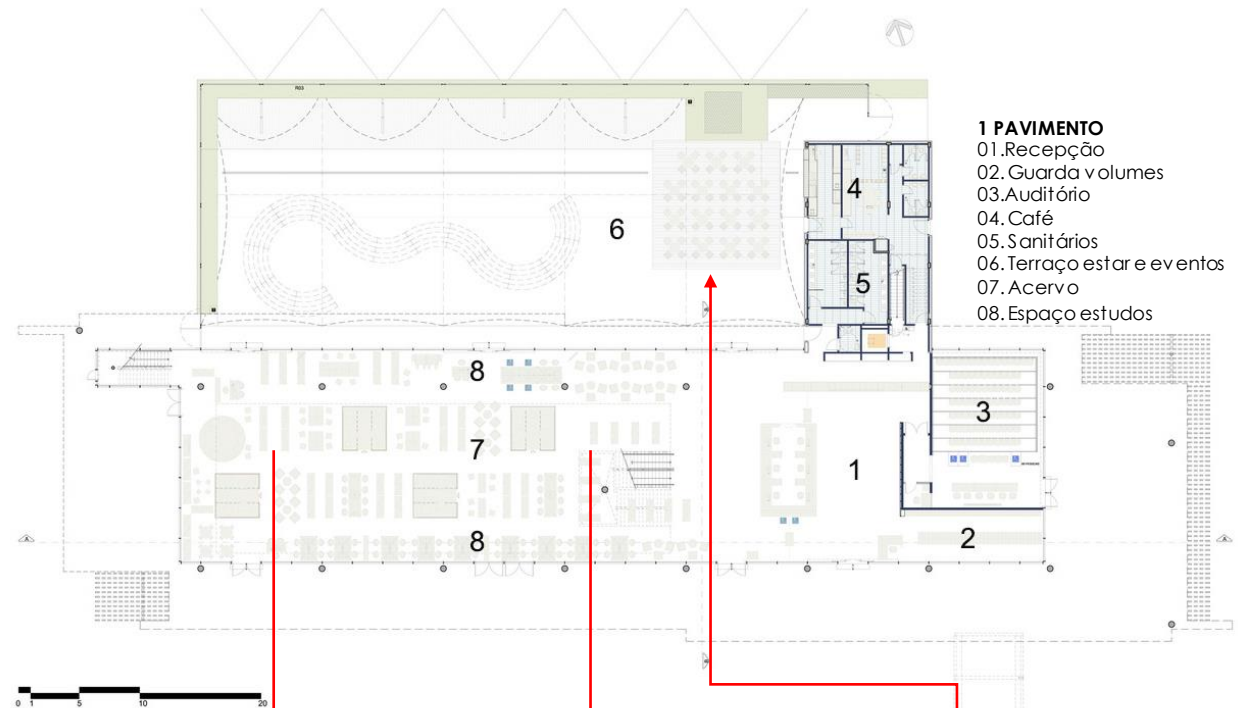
Planta baixa Térreo Biblioteca São Paulo. Fonte: Archdaily(2019b).
